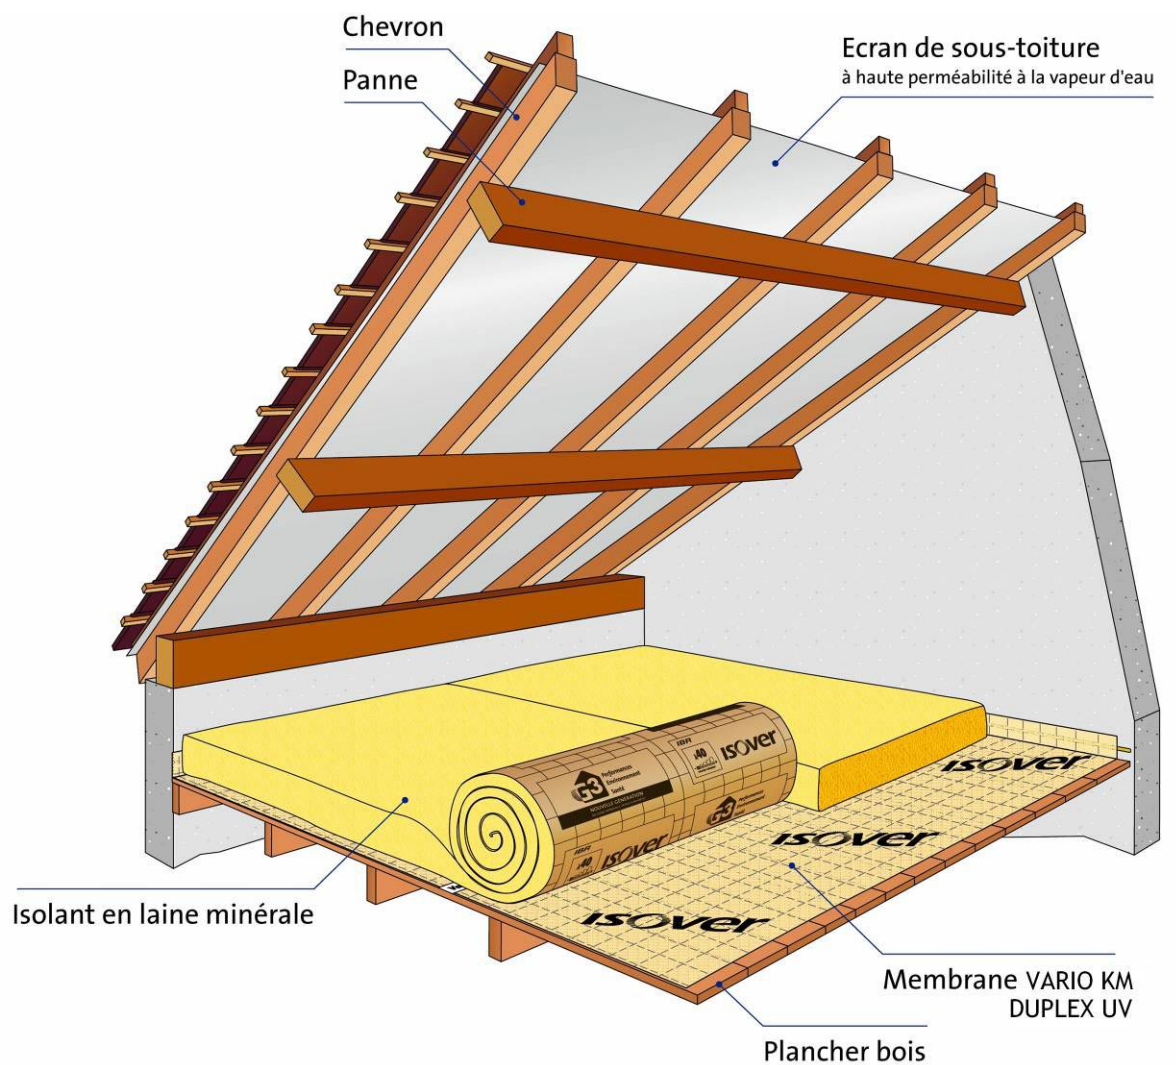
Exemple de mise en œuvre sur plancher de comble perdu
